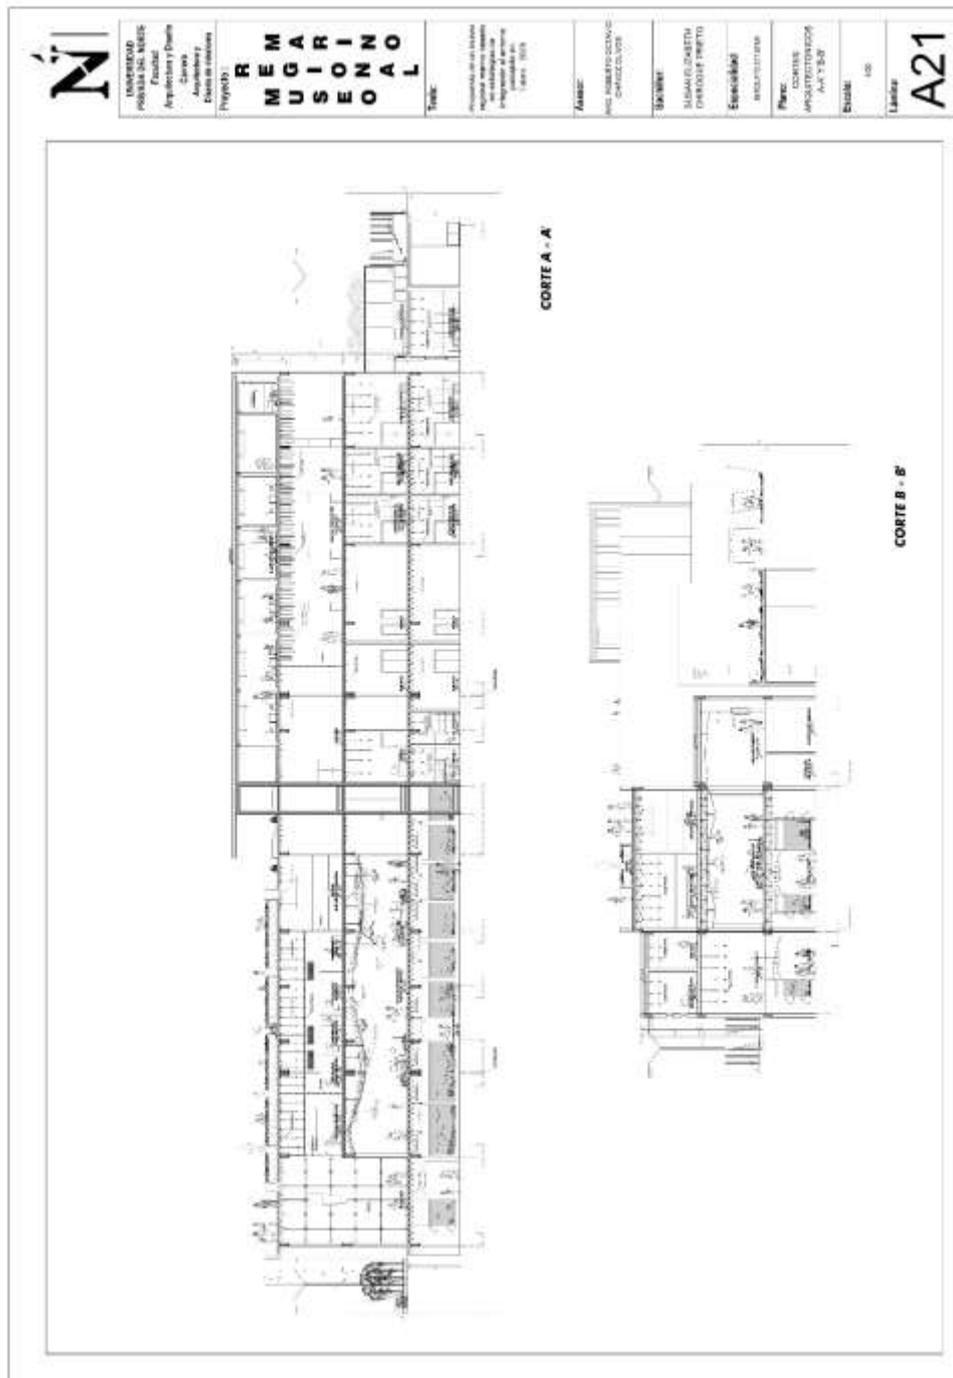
Corte A-A' y B-B' a detalle 1/50.
